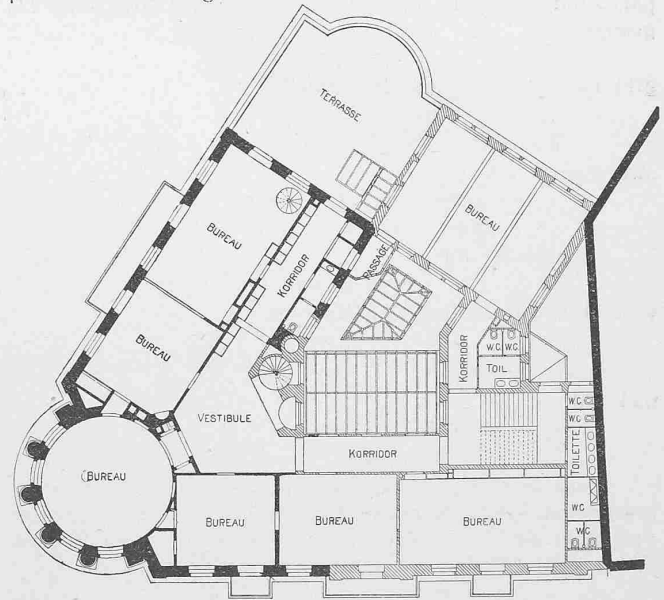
Handelsbank nach dem Umbau. Grundriss vom I. Stock. Masstab 1 : 400.
